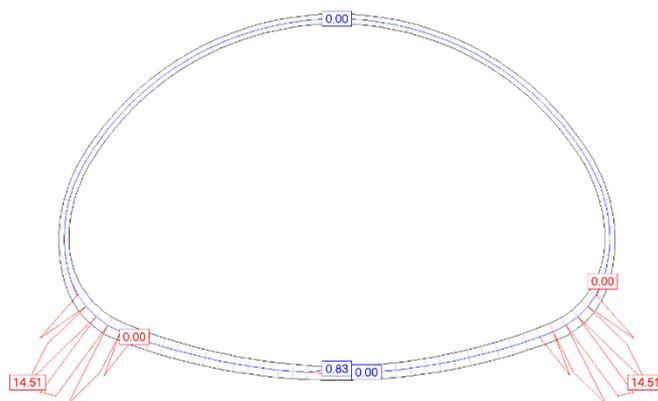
Secção VR1.5. Armaduras de cálculo de flexão (cm<sup>2</sup>/m)
